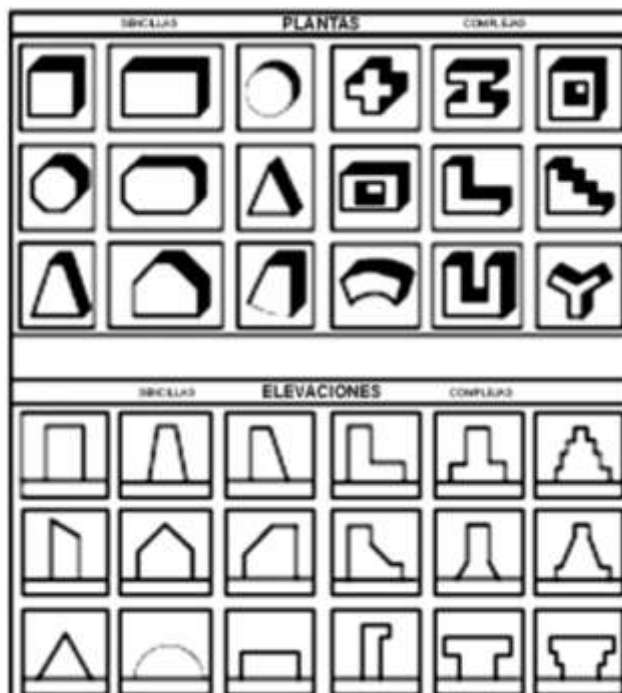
FORMAS EN PLANTA Y ELEVACIÓN.³⁶
